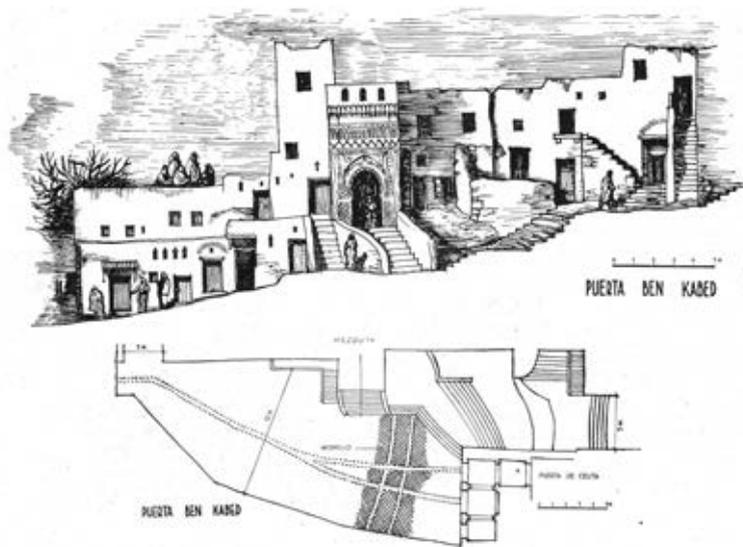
Planta y alzado de la Puerta Ben Kaded de Tetuán. Publicados en la *Revista Nacional de Arquitectura*, n. 26, p. 62. DGA. Madrid.
